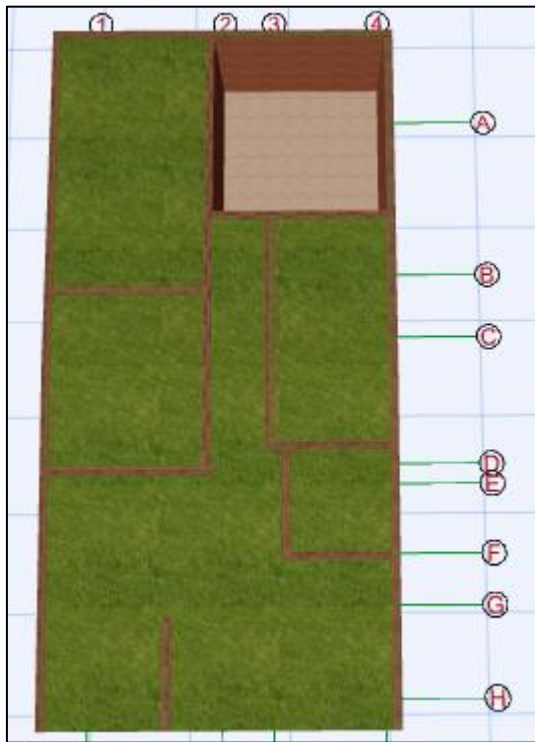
Cubierta verde extensiva diseño 3D en Archicad. Fuente: propia.
